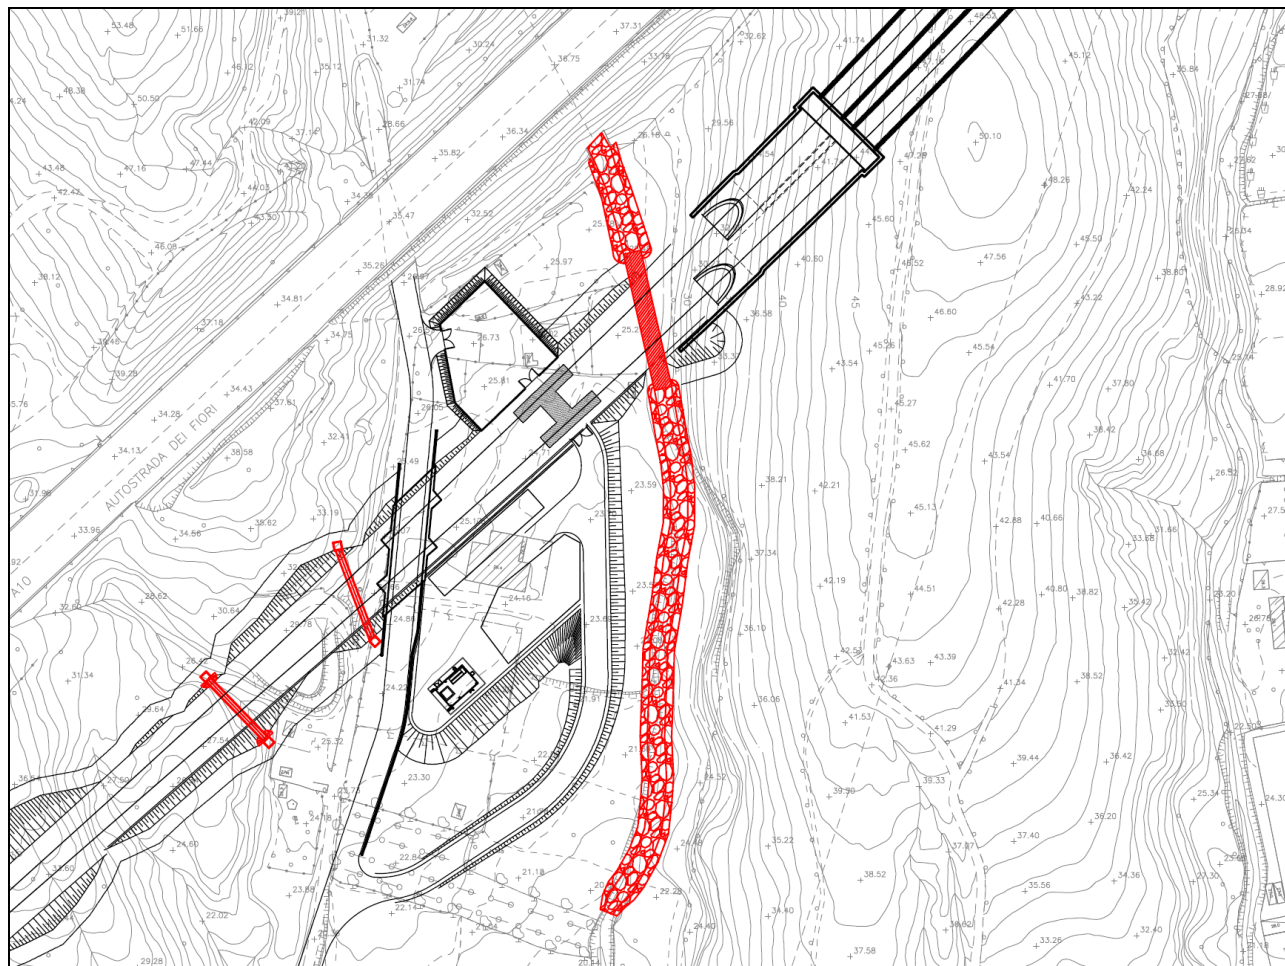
Pianta della sistemazione idraulica del Rio Fasceo
